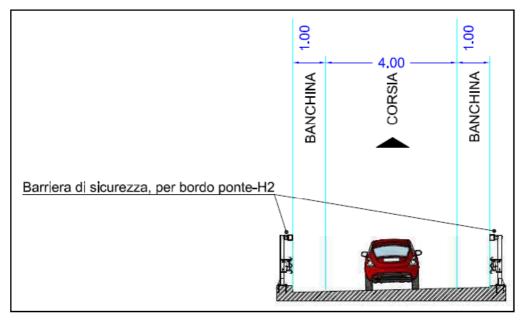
Sezione tipo, rampe a senso unico in viadotto
